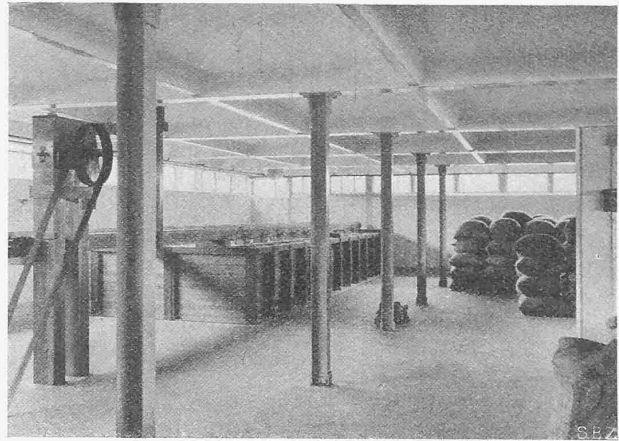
Oberstes Halbgeschoss mit Dach-Untersicht.
